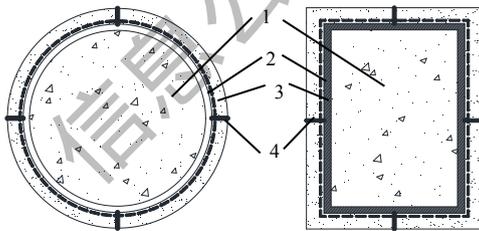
金属网抹水泥砂浆的钢管混凝土柱防火保护构造
